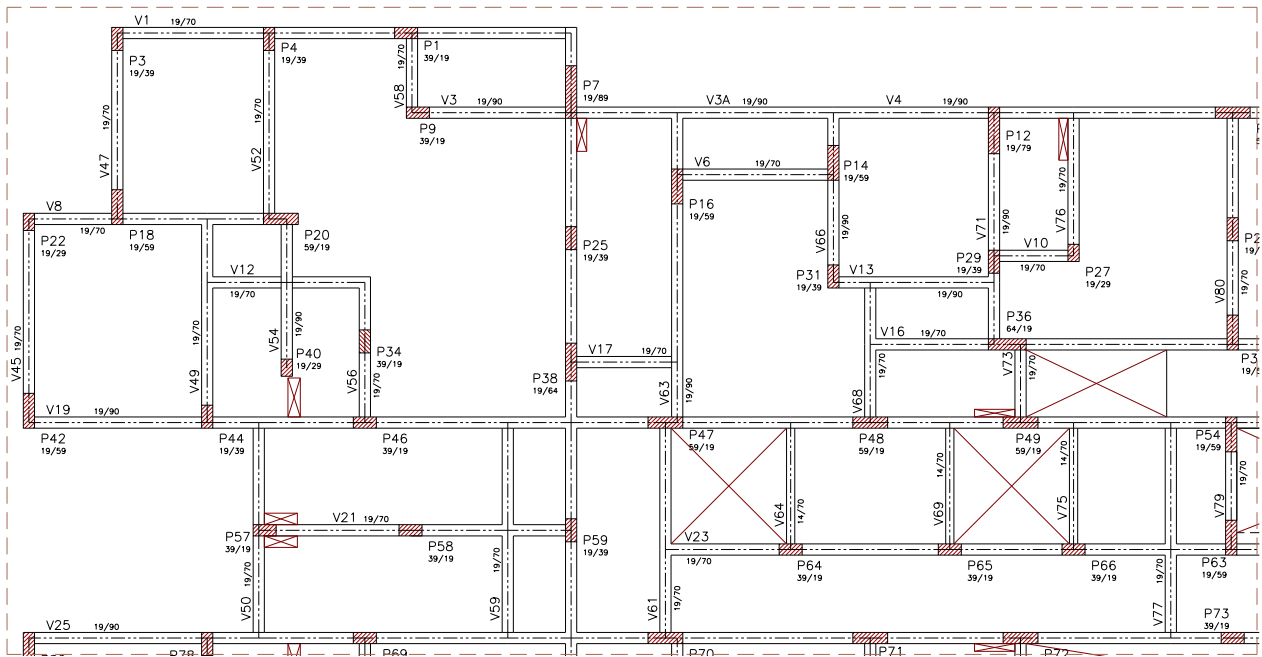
Edifício Vita Belle: detalhe da planta de formas do 1º pavimento
